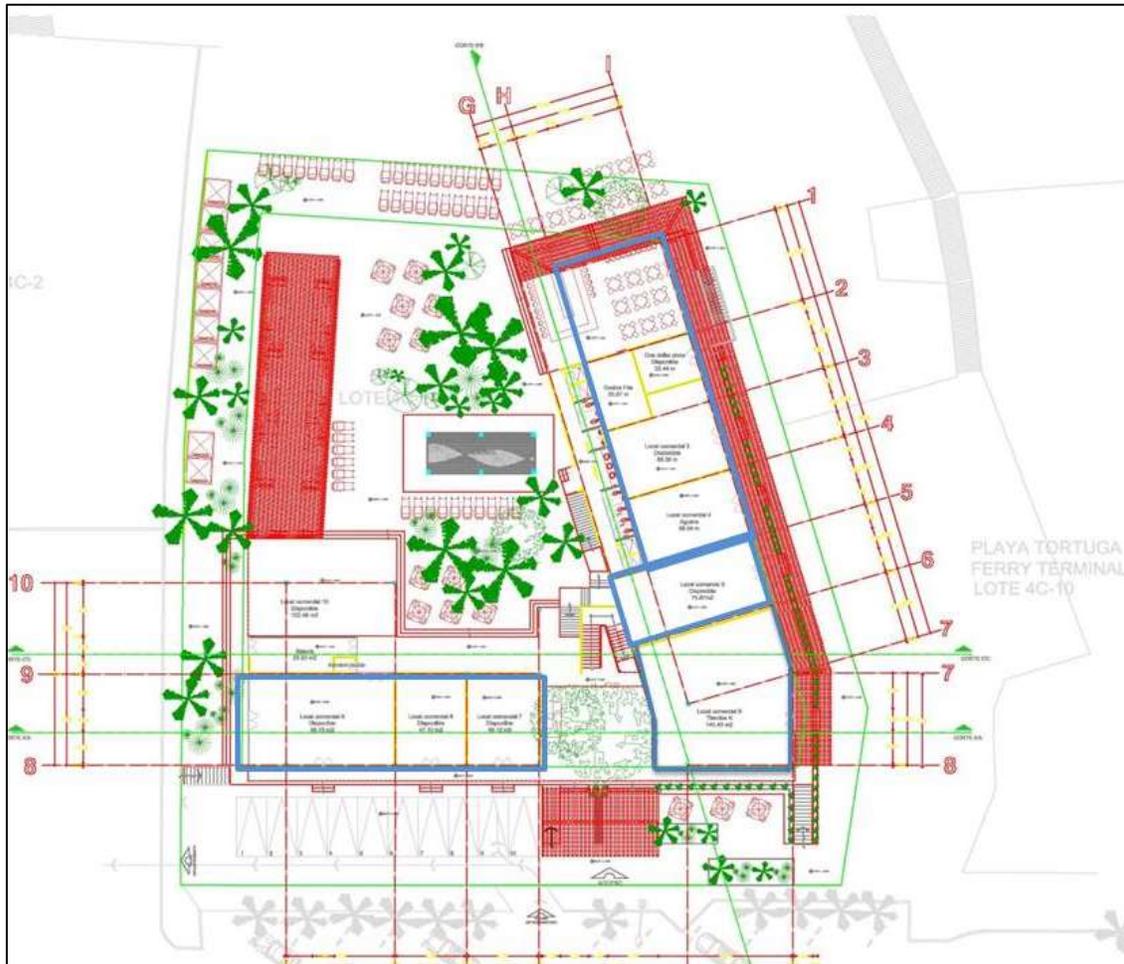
Distribución de locales (color azul) en el proyecto. Adaptado plano de conjunto.
